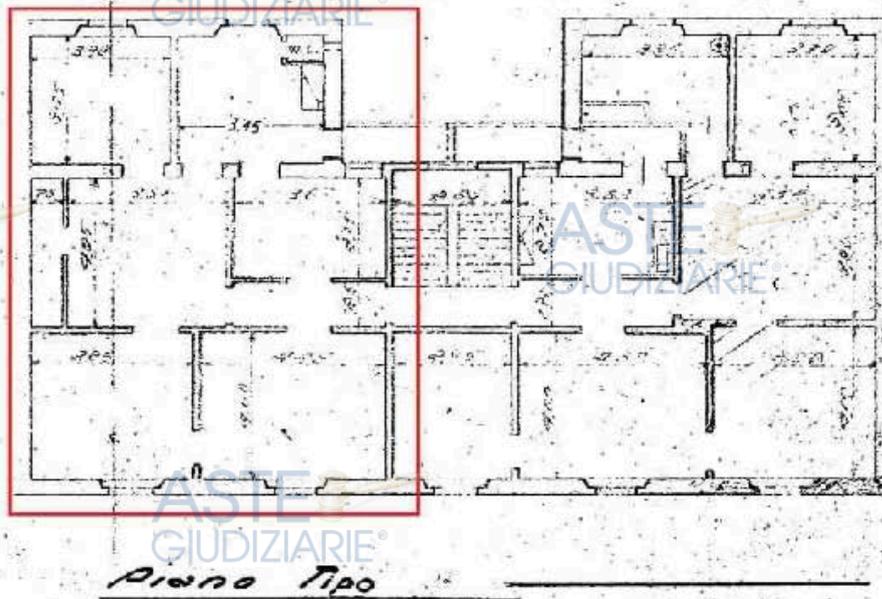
Lic.edilizia n.25694/1951 - Planimetria del piano-tipo (il riquadro identifica La posizione occupata dell'unità immobiliare interessata)
